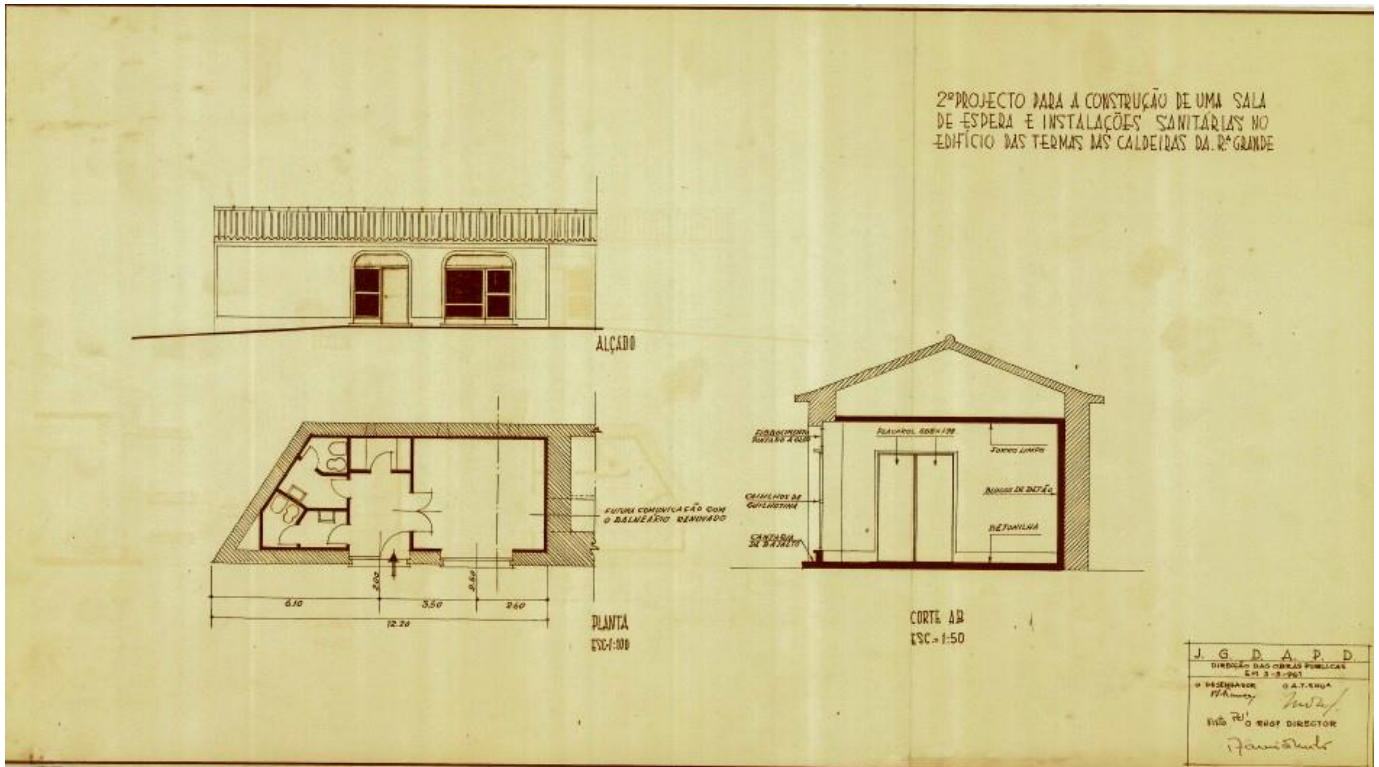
Planta e alçado do 2º projeto de construção de uma sala de espera e de instalações sanitárias
